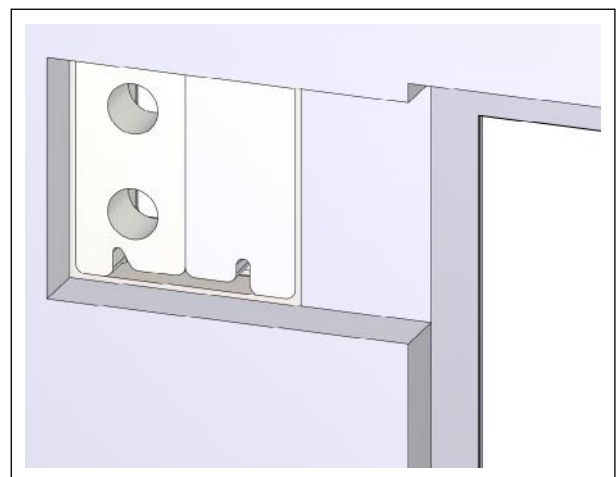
Montageset M-WRG-M/MB mit Füllstück installiert in Rohwand für Einbindung in monolithischen Wandaufbau – Sicht auf die Außenfassade
